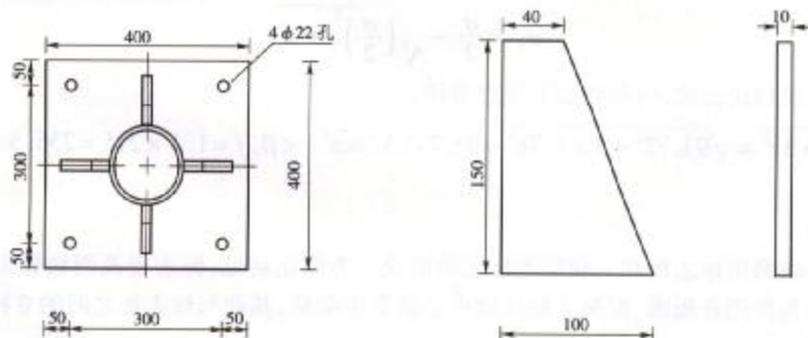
柱脚计算简图(尺寸单位:mm)
